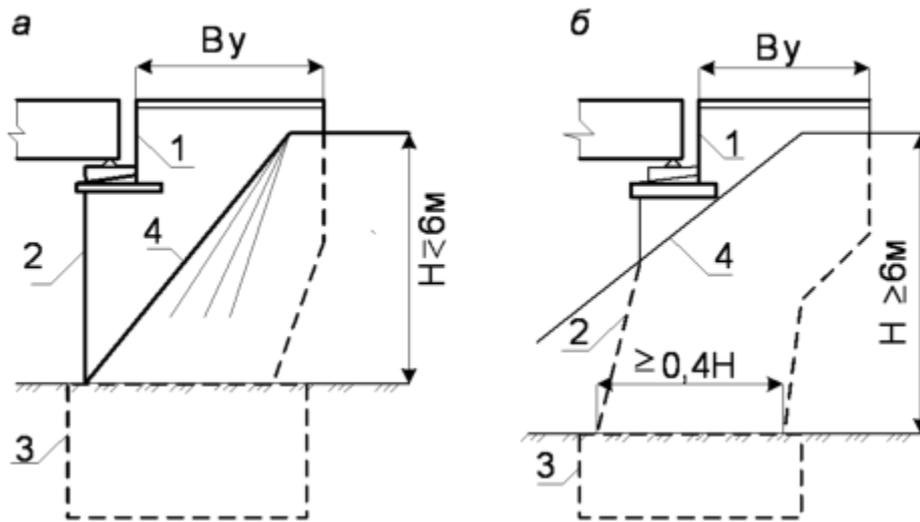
Береговая опора массивная монолитная: а – необсыпного типа; б – обсыпного типа; Н – высота подходной насыпи; 1 – шкафная стенка; 2 – передняя стенка; 3 – фундамент; 4 – конус подходной насыпи
